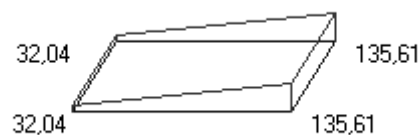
Схема до розрахунку величини навантаження на фундамент
